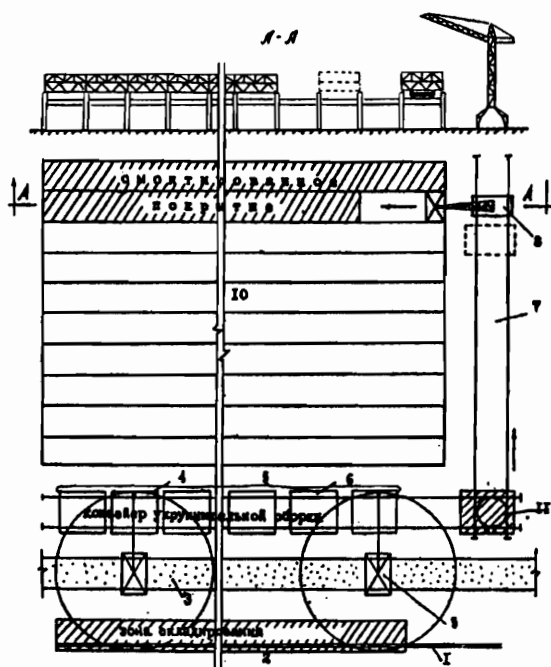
Схема конвейерной линии по монтажу покрытий одноэтажных производственных зданий: 1 - железнодорожный путь; 2 - склад металлоконструкций; 3 - площадка и проезд для обслуживания конвейера; 4 - конвейерная линия; 5 - зона сборки блоков; 6 - зона отделочных и кровельных работ; 7 - рельсовый путь; 8 - монтажный кран; 9 - кран укрупнительной сборки; 10 - строящийся корпус; 11 - поворотная платформа для подачи укрупненных блоков в зону монтажа
